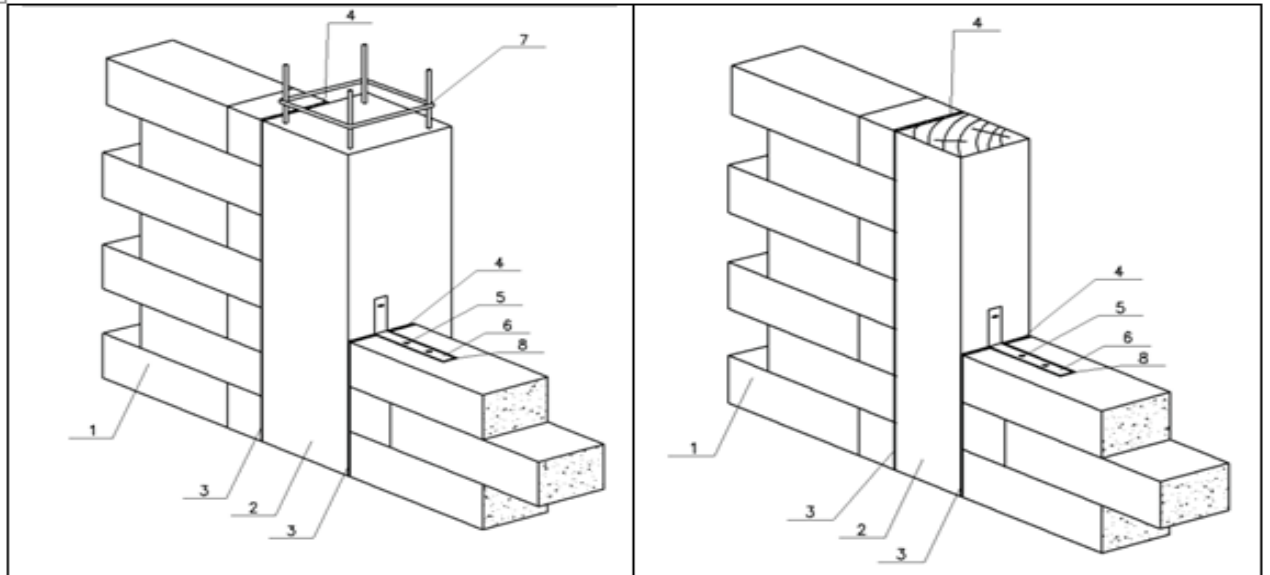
Фрагмент стінової кладки газобетонних блоків при каркасно-монолітному будівництві, де: 1 – кладка з газобетонних блоків; 2 – залізобетонна колонна; 3 – еластичний силіконовий чи акриловий герметик; 4 – мінераловатний утеплювач товщиною 20 – 25 мм; 5 – анкер; 6 – металевий кутик; 7 – арматурний каркас залізобетонної колони; 8 – штраба в газобетонному блоці під металевий кутик.
